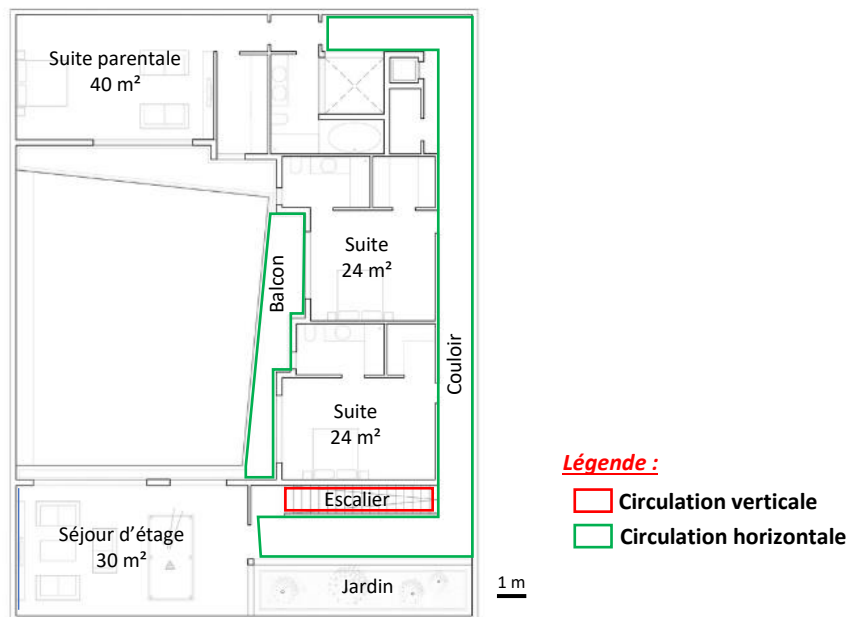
Plan du 1er étage Source : M. Monti, 2017
